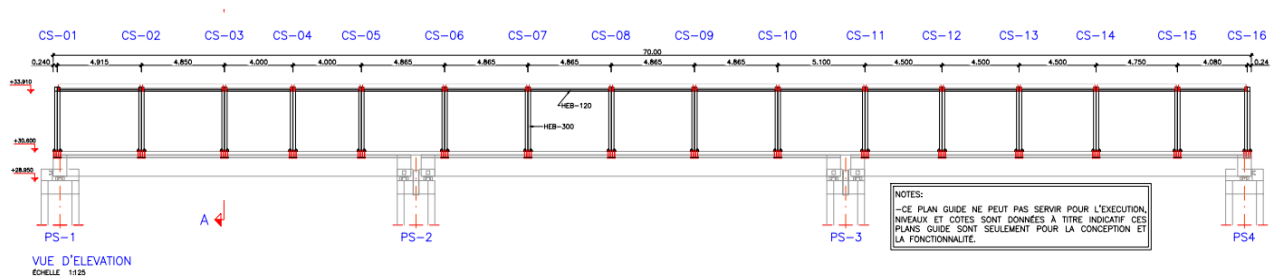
Vue en élévation de la toiture de la passerelle SNTF
